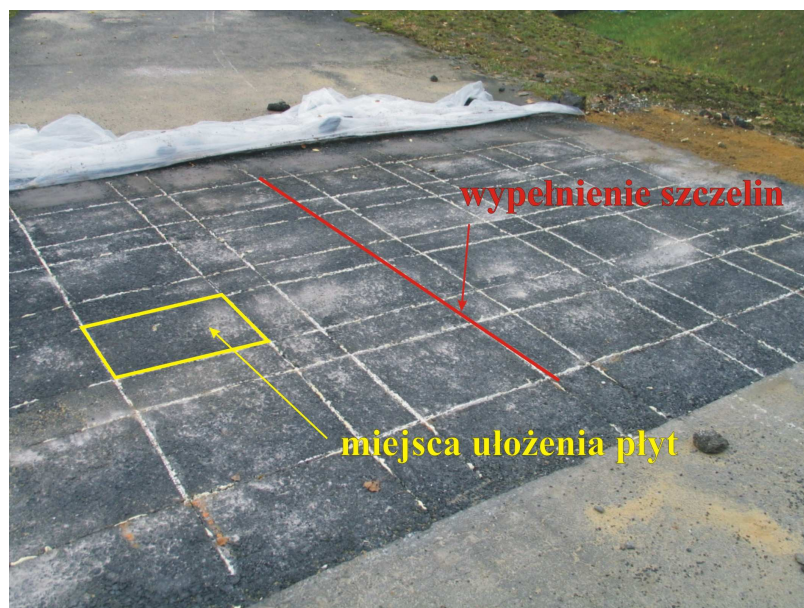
Wykonywanie warstwy wiążącej z betonu asfaltowego
